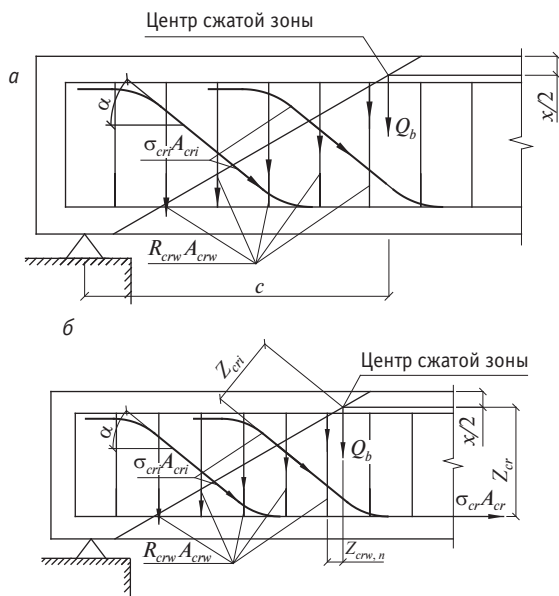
Схема усилий в сечении, наклонном к продольной оси бетонного элемента:
